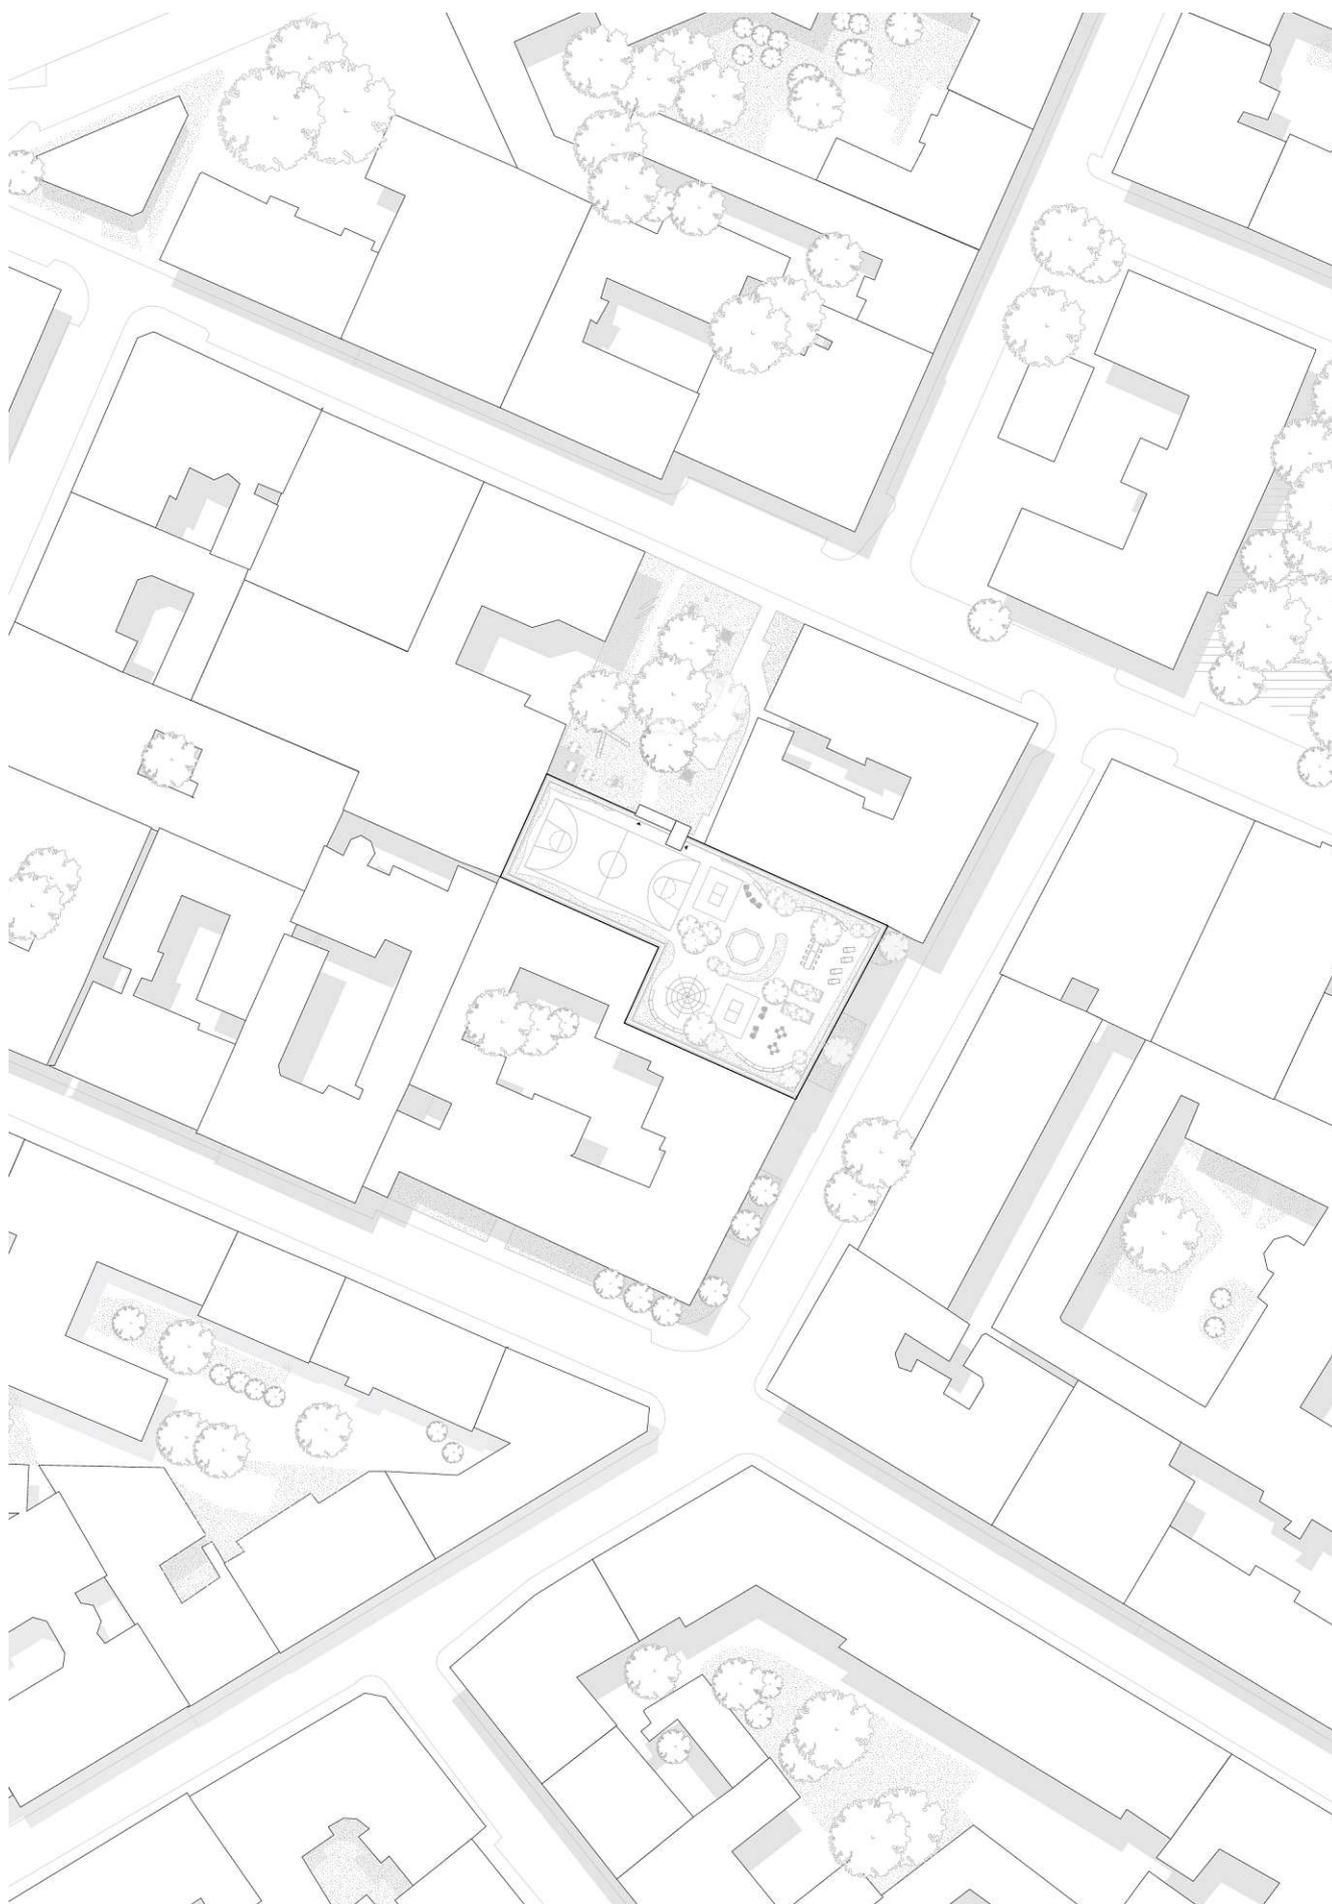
Parkhaus Viktoriagasse - Lageplan nach Transformation - M 1:1000
